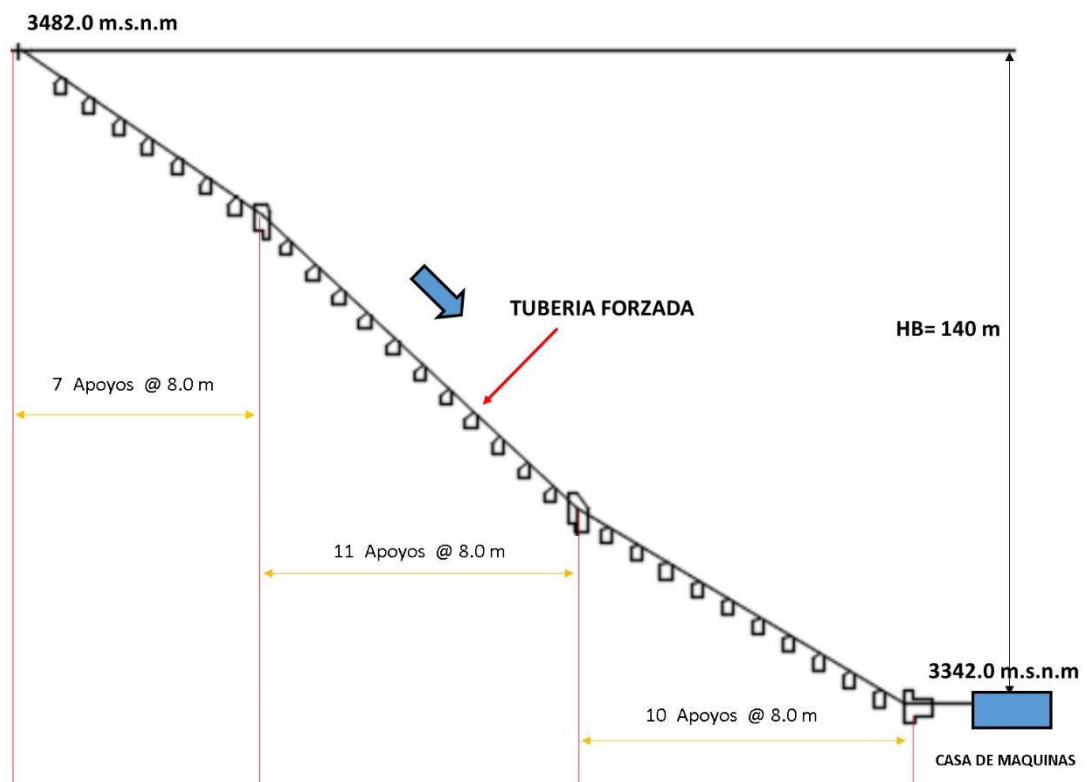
Perfil de la tubería forzada y Apoyos
